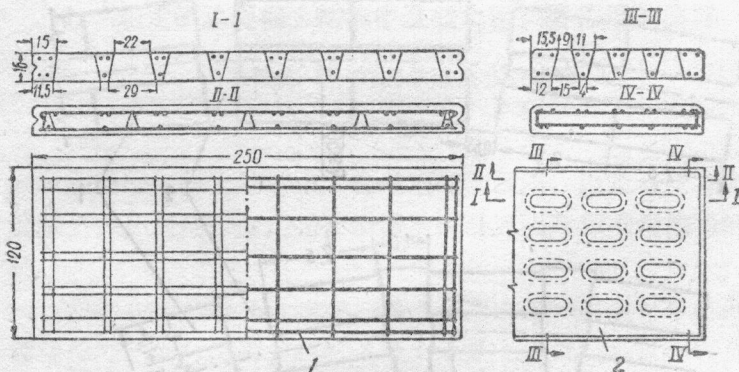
鋪于临时公路上的帶狀路面用的網格型鋼筋混凝土板
